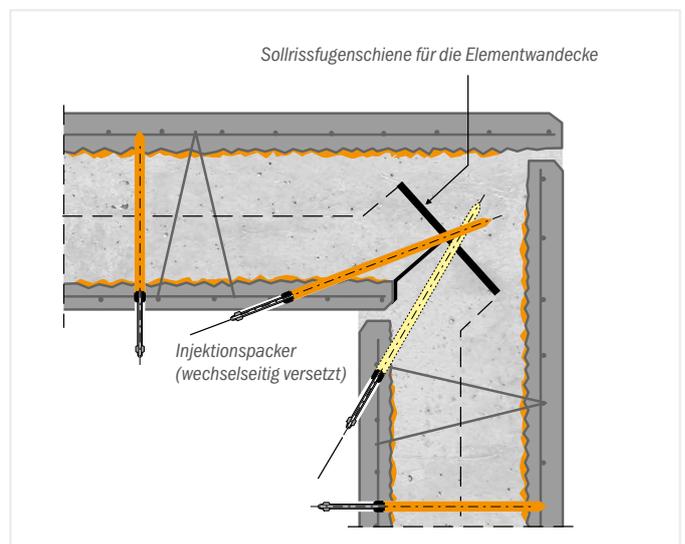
Nachträgliche Abdichtung einer Elementwanddecke mit einer Sollrissfugenschiene [7]
